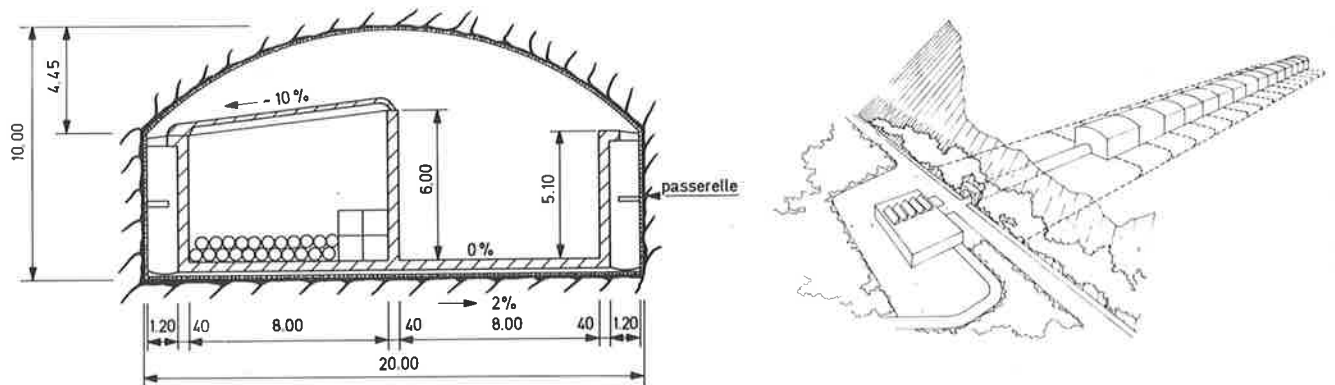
VARIANTE 1 / Coupe transversale et ensemble
